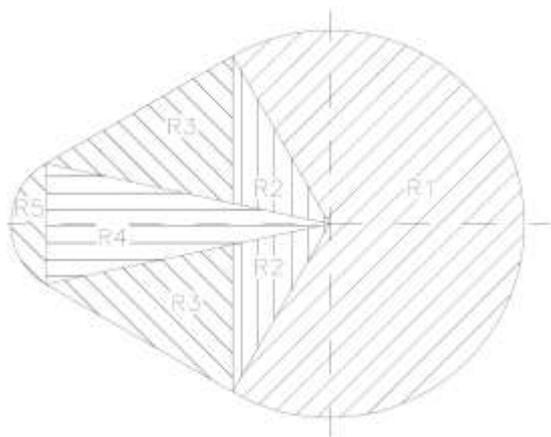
Planta Horno donde se proyectan R1, R2, R3, R4 y R5
